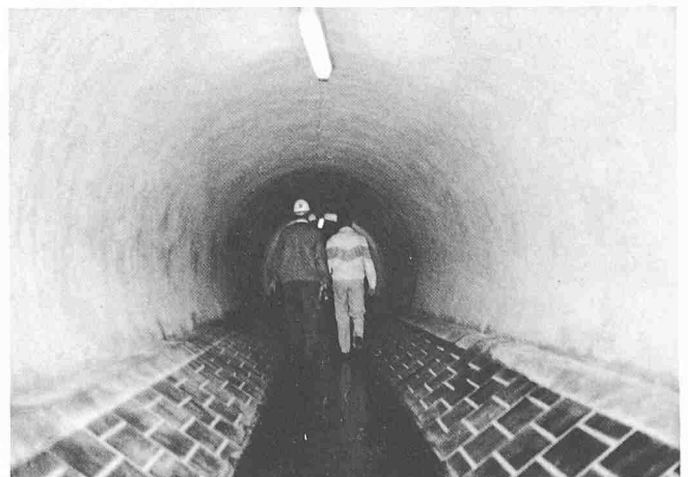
Mit Spritzbeton ausgekleideter Abwasserstollen. Oberflächenglättung
